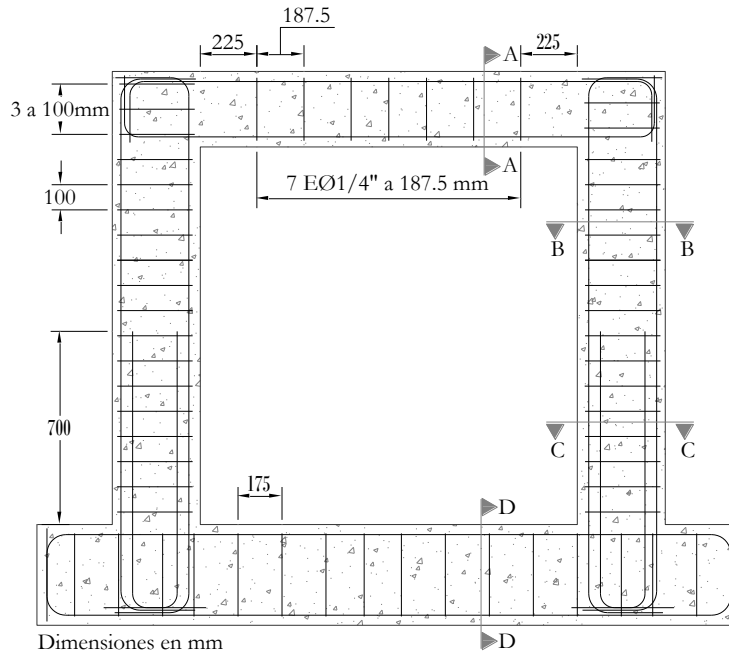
Detallado del refuerzo del pórtico *P3
